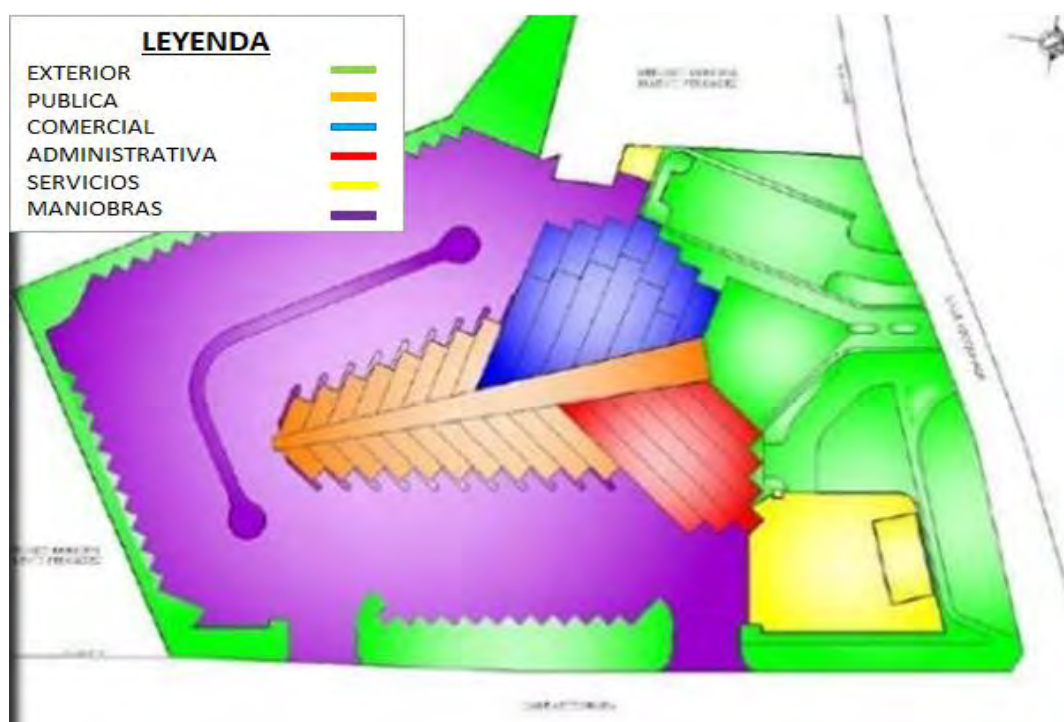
Plano de zonificación del Terminal Terrestre de Masaya.
